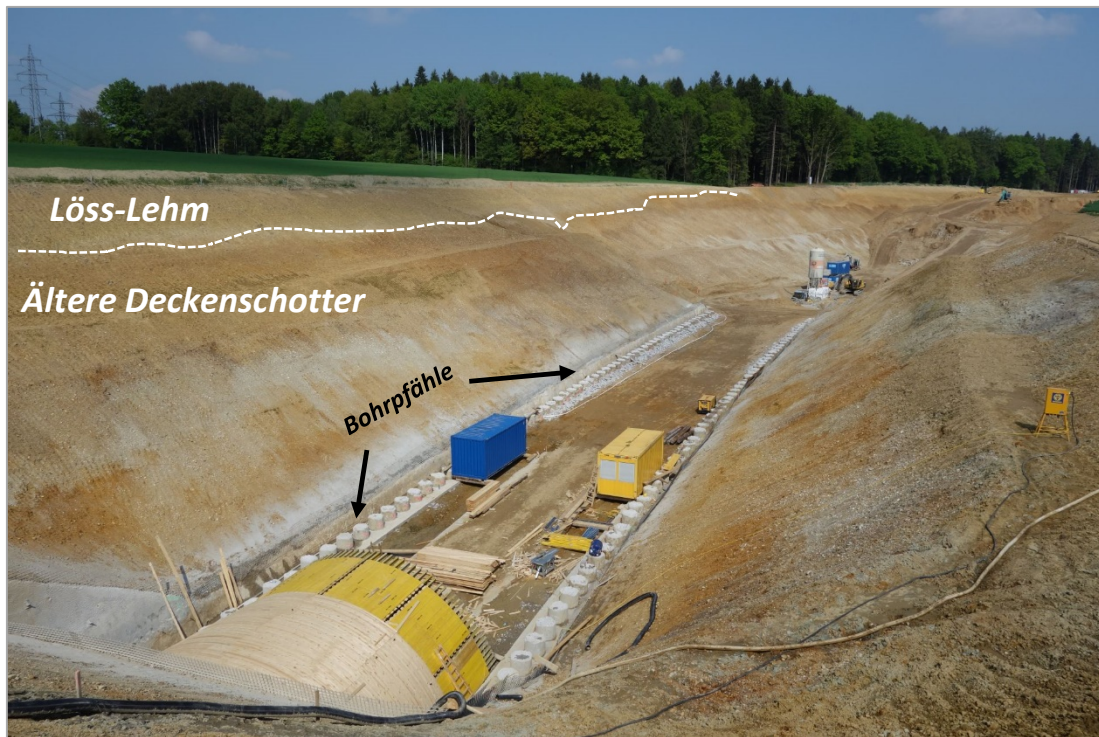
Umfahrung Lambach-Nord- Aufschlusspunkt 3, Tunnelportal Ost: Das Tunnelbauwerk liegt innerhalb der „Älteren Deckenschotter“; deutlich erkennbar sind die Bohrpfähle zur Sicherung der Deckelbauweise des Tunnels (Foto: H. Peresson).
